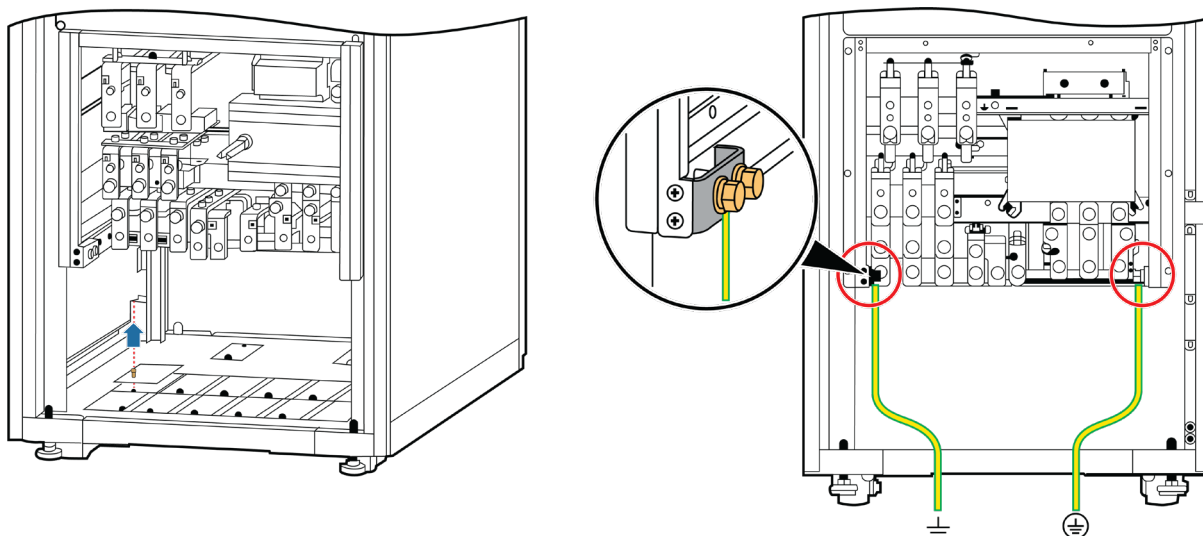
CUBIERTA INFERIOR DEL GABINETE Y CONEXIONES DE PROTECCIÓN A TIERRA
